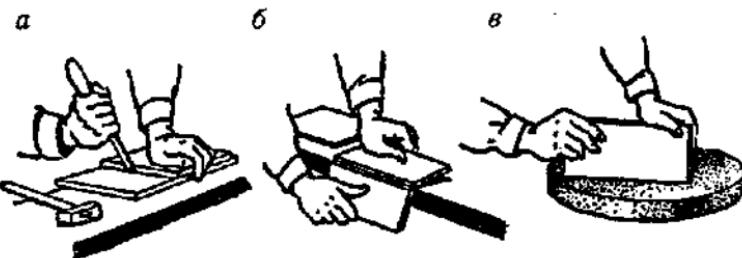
Подготовка плиток: а — резка; б — разламывание; в — приточка кромки.
